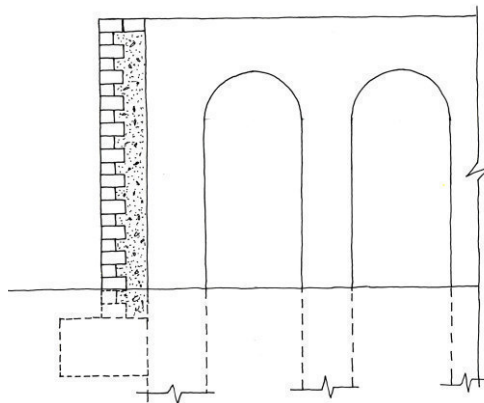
Sección transversal del refuerzo de un estribo de alcantarilla
